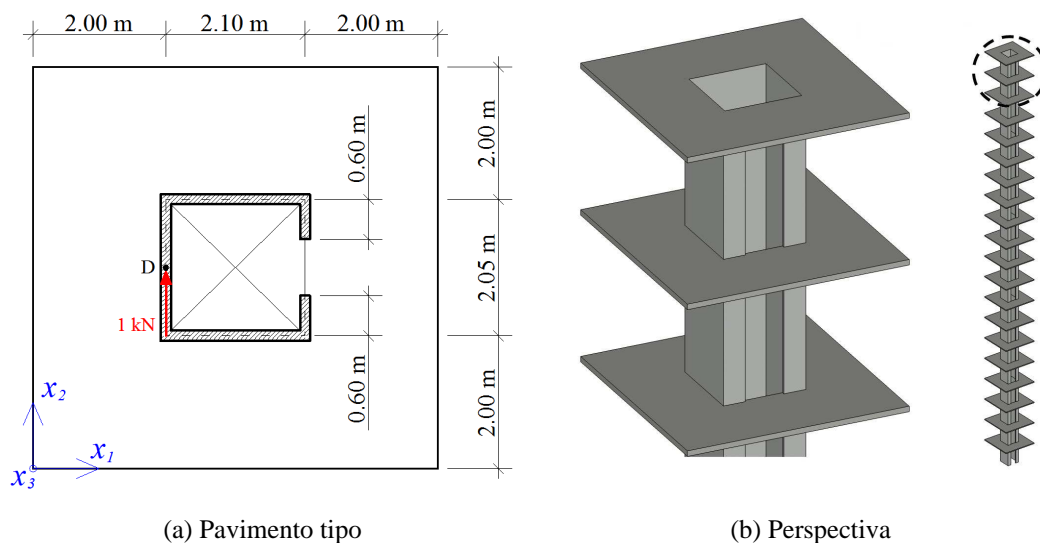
Exemplo 5: Núcleo rígido parcialmente fechado por lajes
